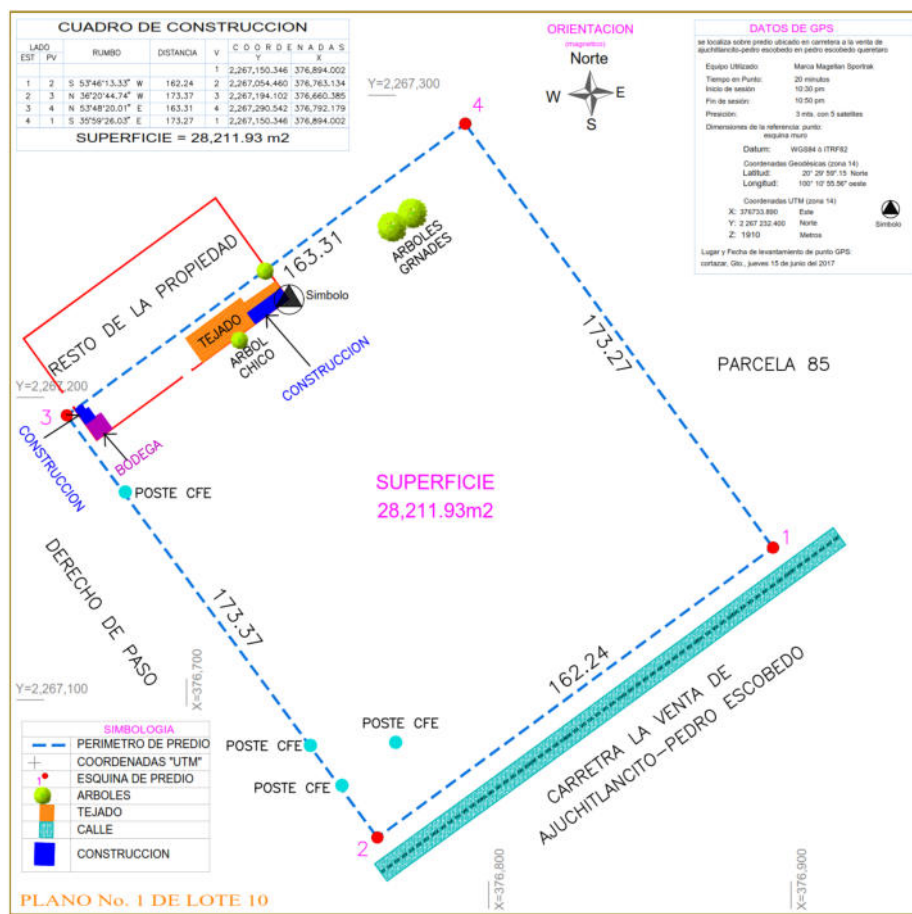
Plano Topográfico (superficie arrendada)
